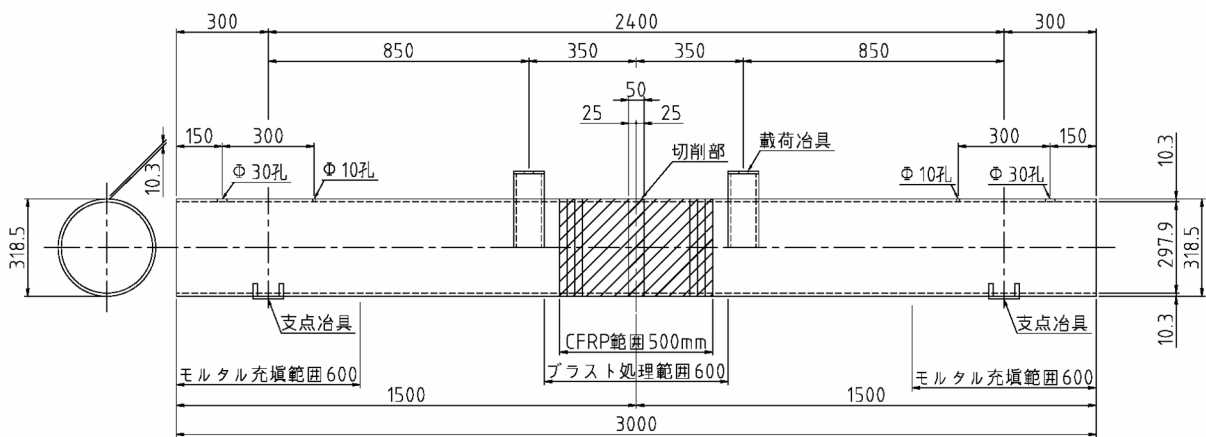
鋼管供試体の概略 (No.2 供試体) (単位: mm)
